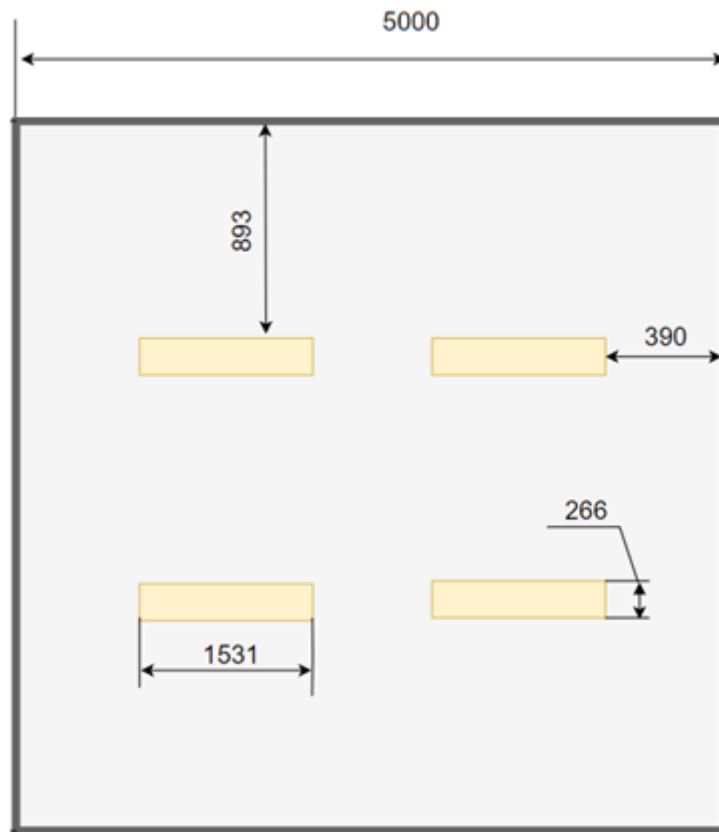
План помещения и размещения светильников люминесцентными лампами
